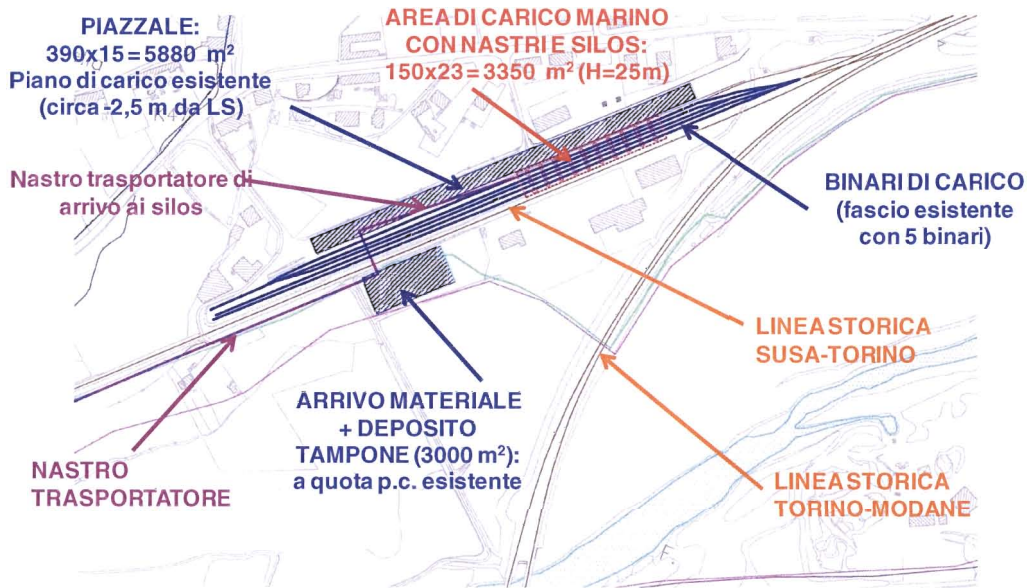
Area di carico di Susa: soluzione 3 (Bussoleno): stralcio planimetrico
